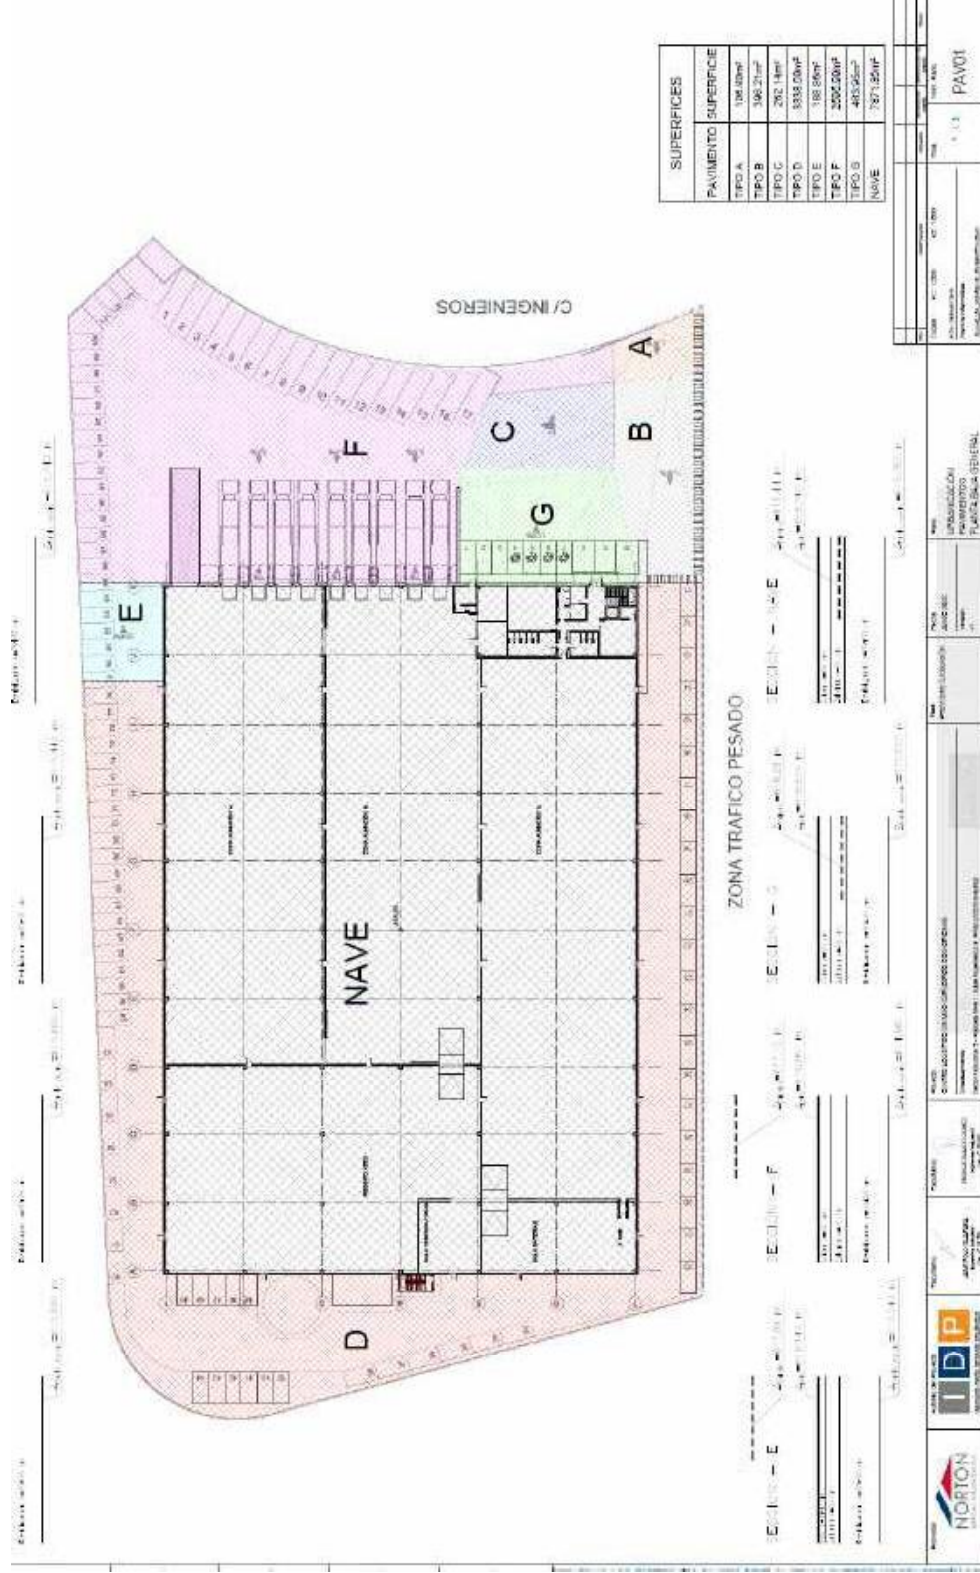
Plano de implantación prevista. Fte: Norton Edificios Industriales S.A.
